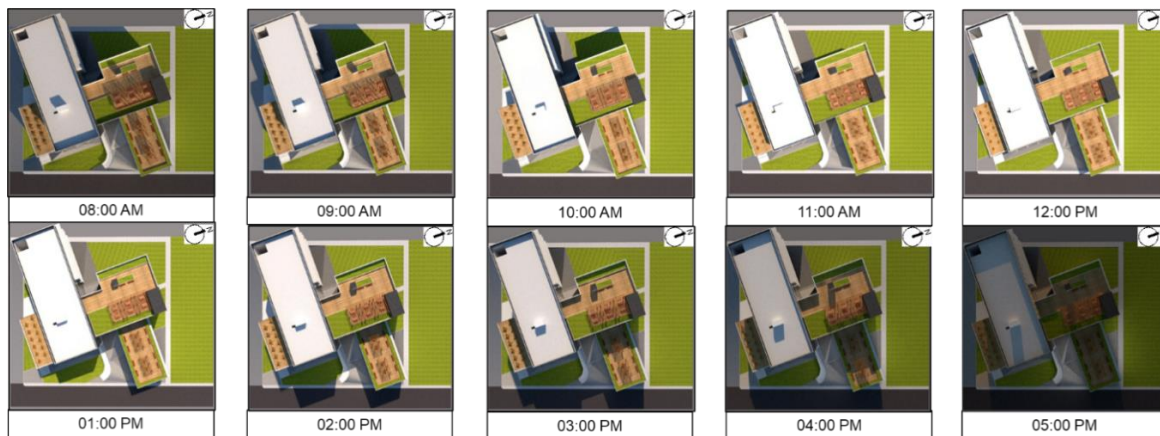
Vista en planta del recorrido solar en solsticio de invierno.
